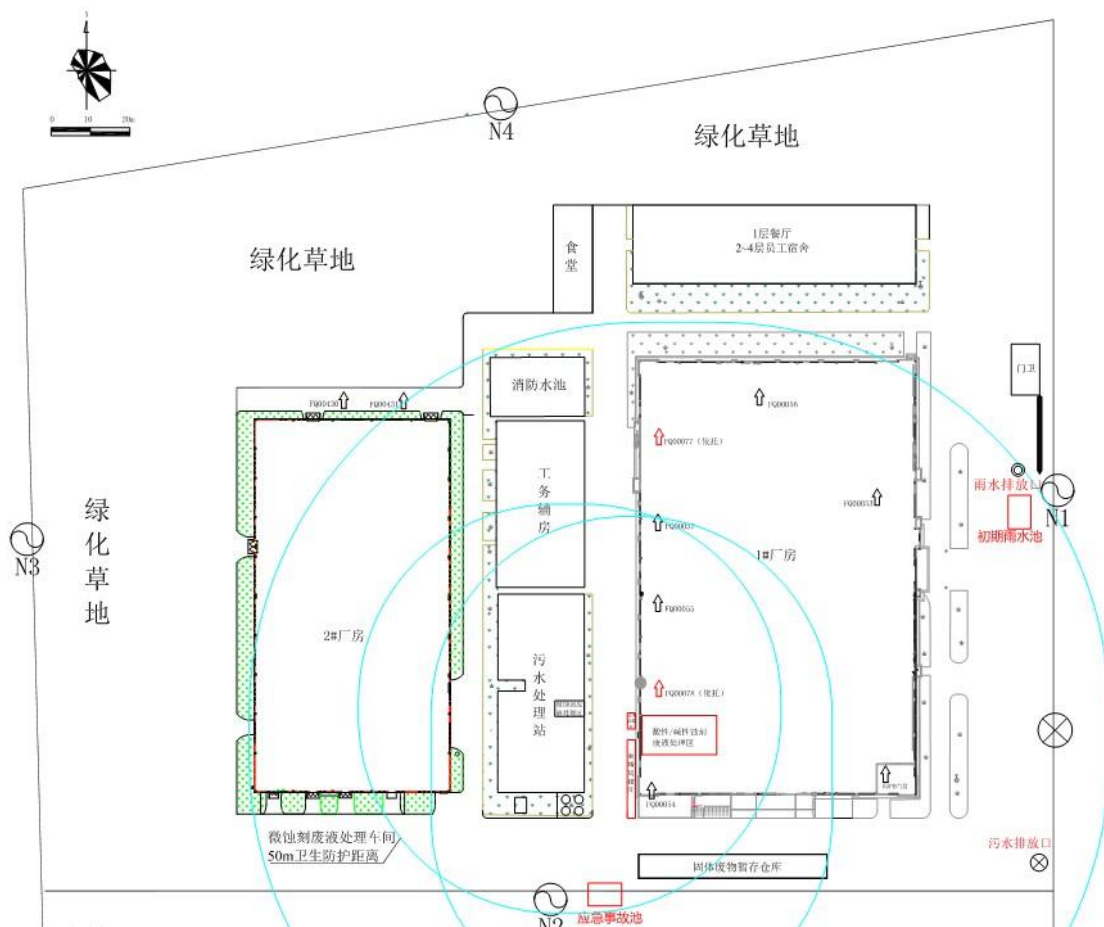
昆山旭发电子有限公司厂区平面布置图
